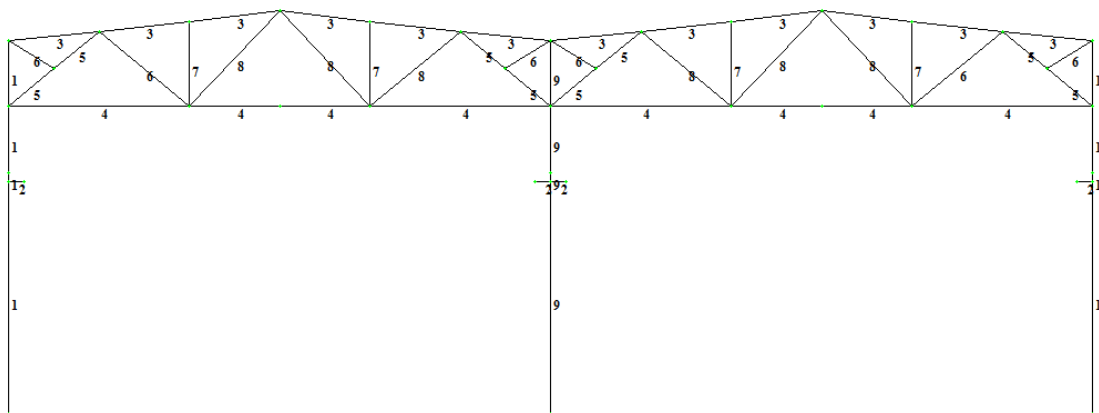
Схема завдання жорсткостей елементам каркаса будівлі
